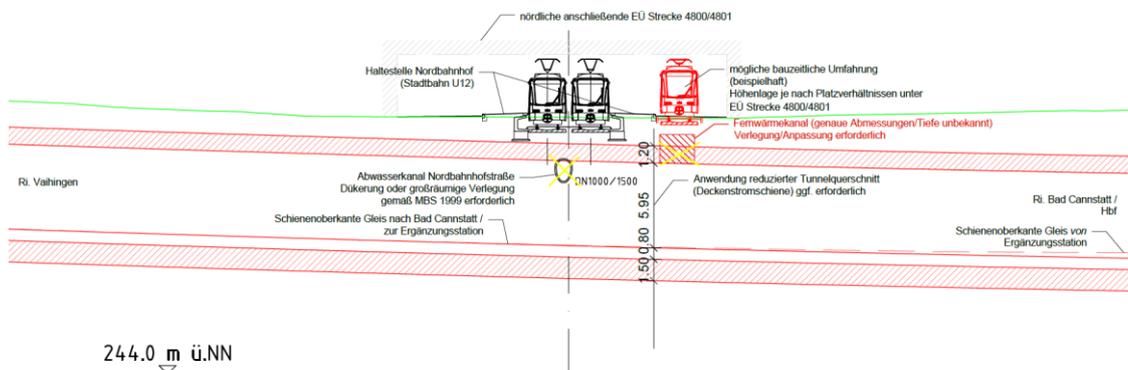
Querschnitt Nordbahnhofstraße mit querendem Tunnel (Anlage 5.5)
